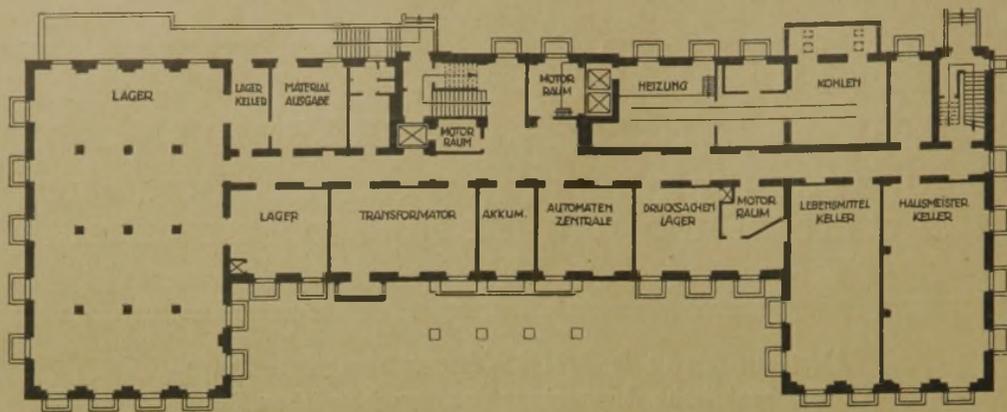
Grundriß des Kellergeschoßes. Maßstab 1:500.
